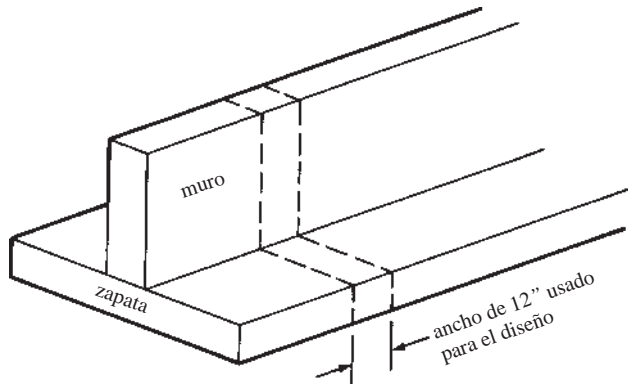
Ancho de diseño de un pie para una zapata corrida para muro.
